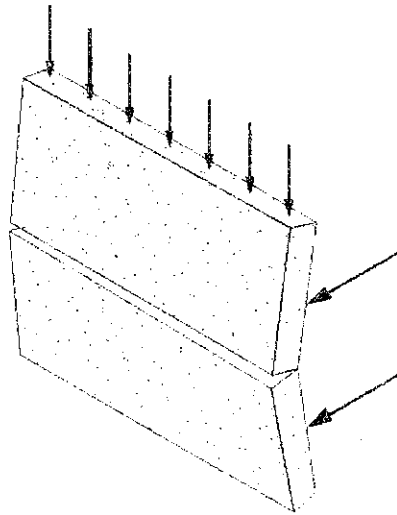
Rupture à mi-hauteur due à la flexion hors plan.
